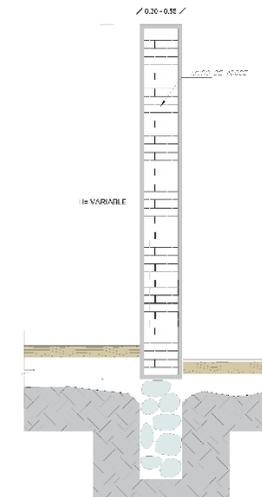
Detalle de mampostería de adobe Fuente: elaboración propia
